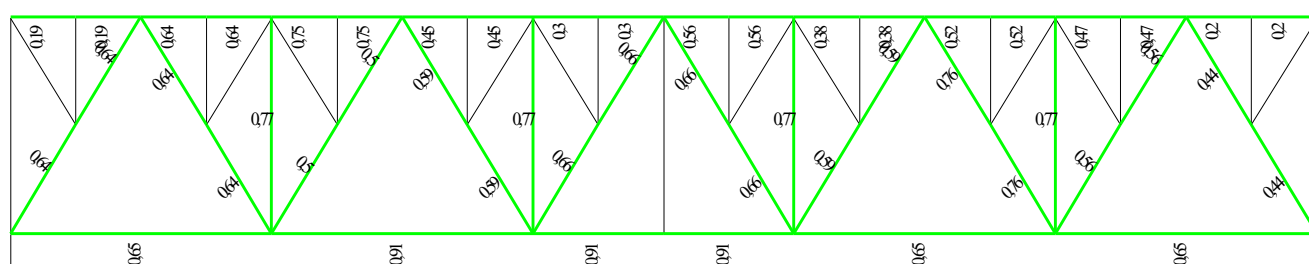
Коэффициенты использования элементов стропильной фермы
